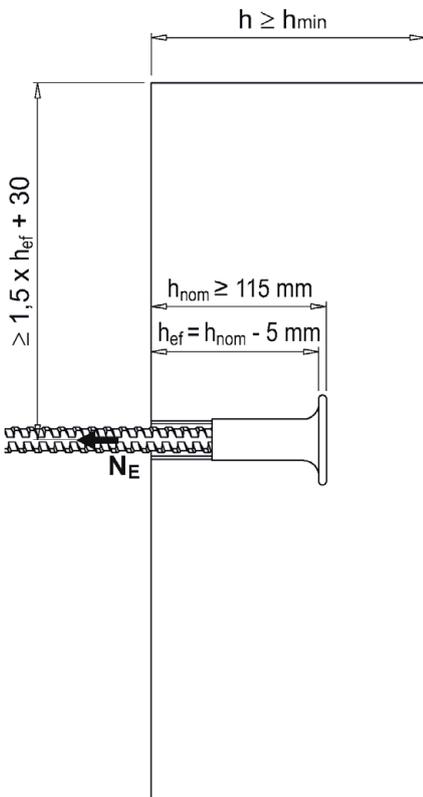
Einbauzustand Gesimsanker mit Ankerstabstahl (DOKA-Ankerstab 15,0mm nach Z-12.5-96) bei reiner Zugbeanspruchung
